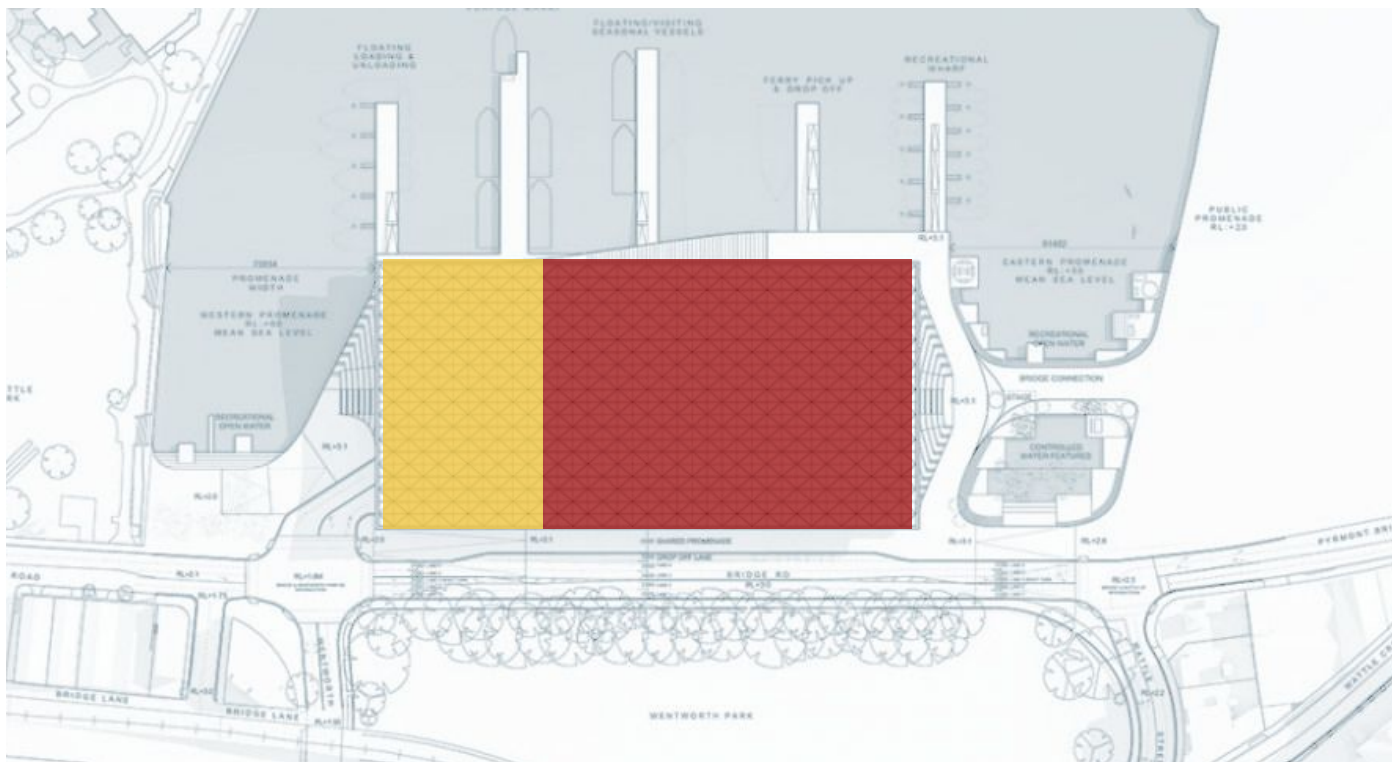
ESQUEMA PRIMER NIVEL THE PLAN, 3XN, 2020
